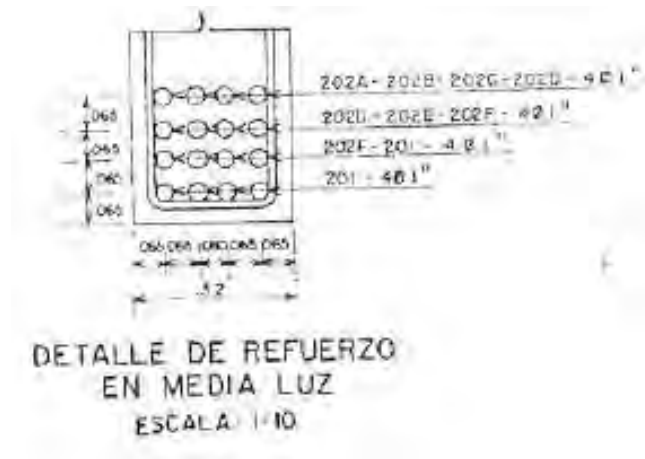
Distribución del refuerzo longitudinal en el centro de la luz de las vigas.
